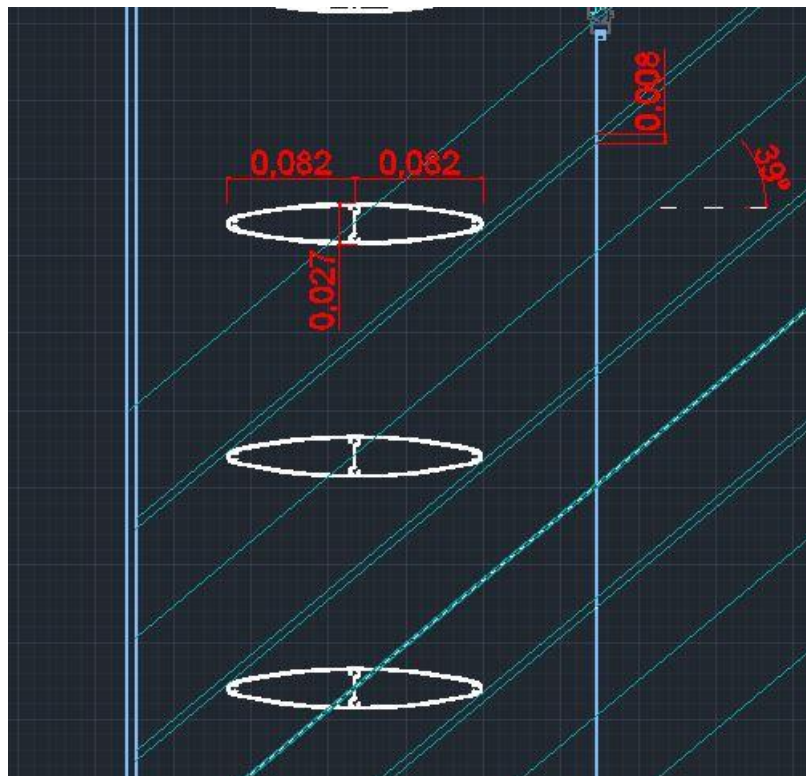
Caso de Estudo 1 – Vista lateral de lamela, com dimensão (m) de altura de lamela e largura de lamela interior e exterior
